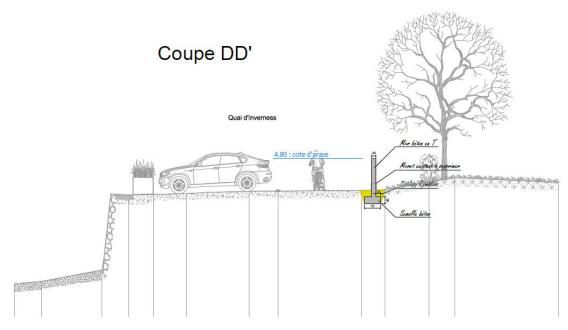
coupe-type d'un mur en T bordant l'étier du Pouliguen (44) (auteur : Artelia)
